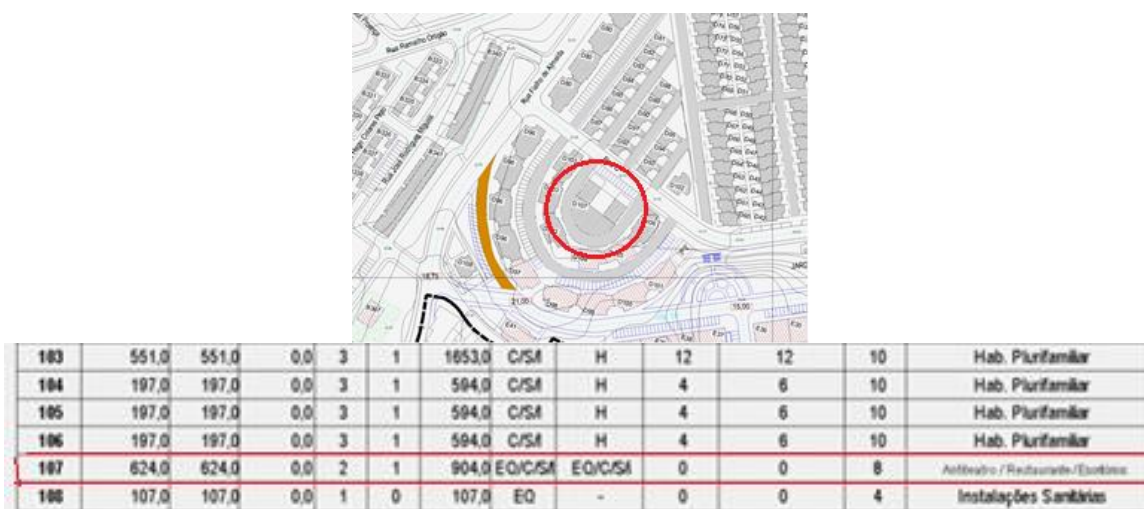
Extrato da Planta de Implantação e respetiva legenda.
